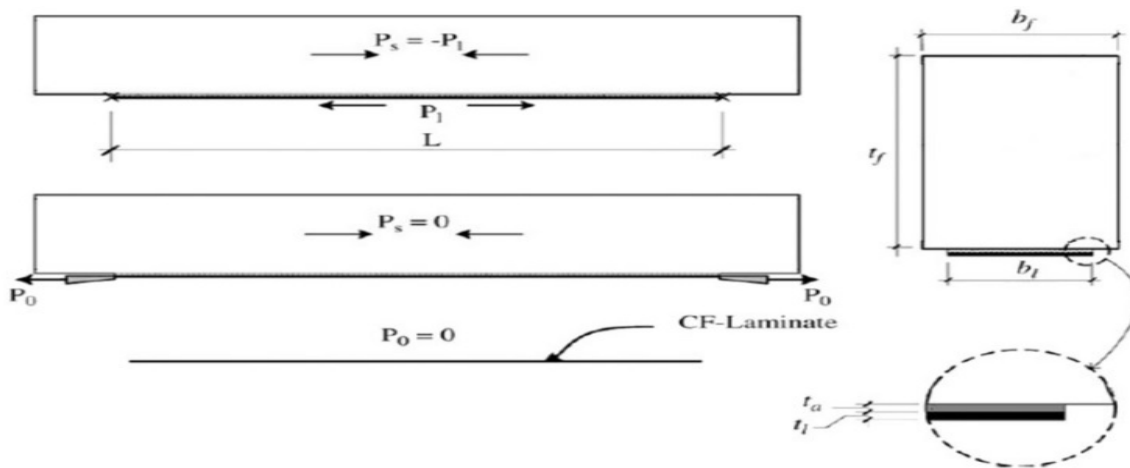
Poutre en béton simplement appuyée renforcée par collage d'une plaque composite.
